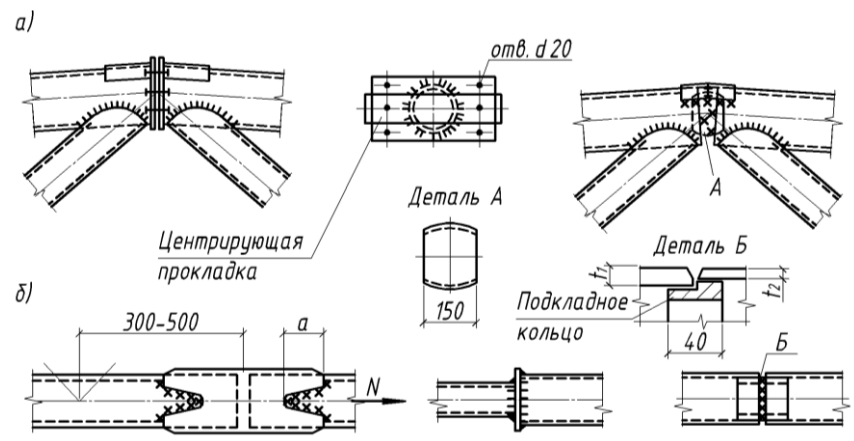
Нижний укрупнительный стык полуферм
